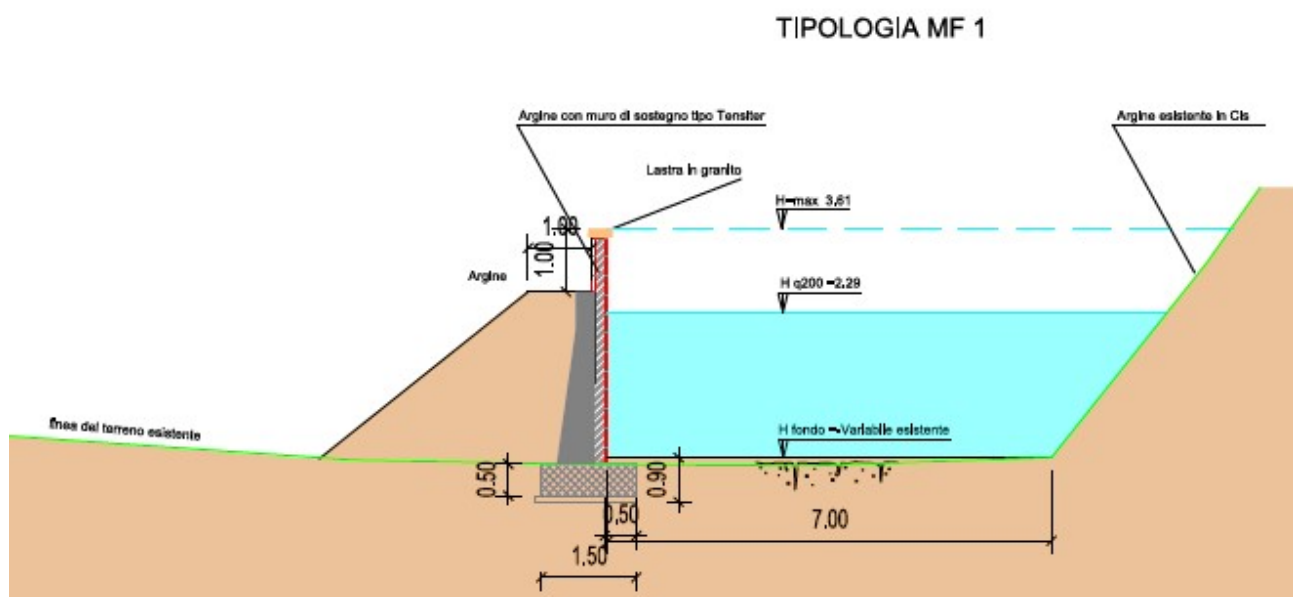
lotto 3 - estratto T-02-02 tratto a monte ponte ferroviario -sezione tipologica con muro in sinistra con funzione di argine
